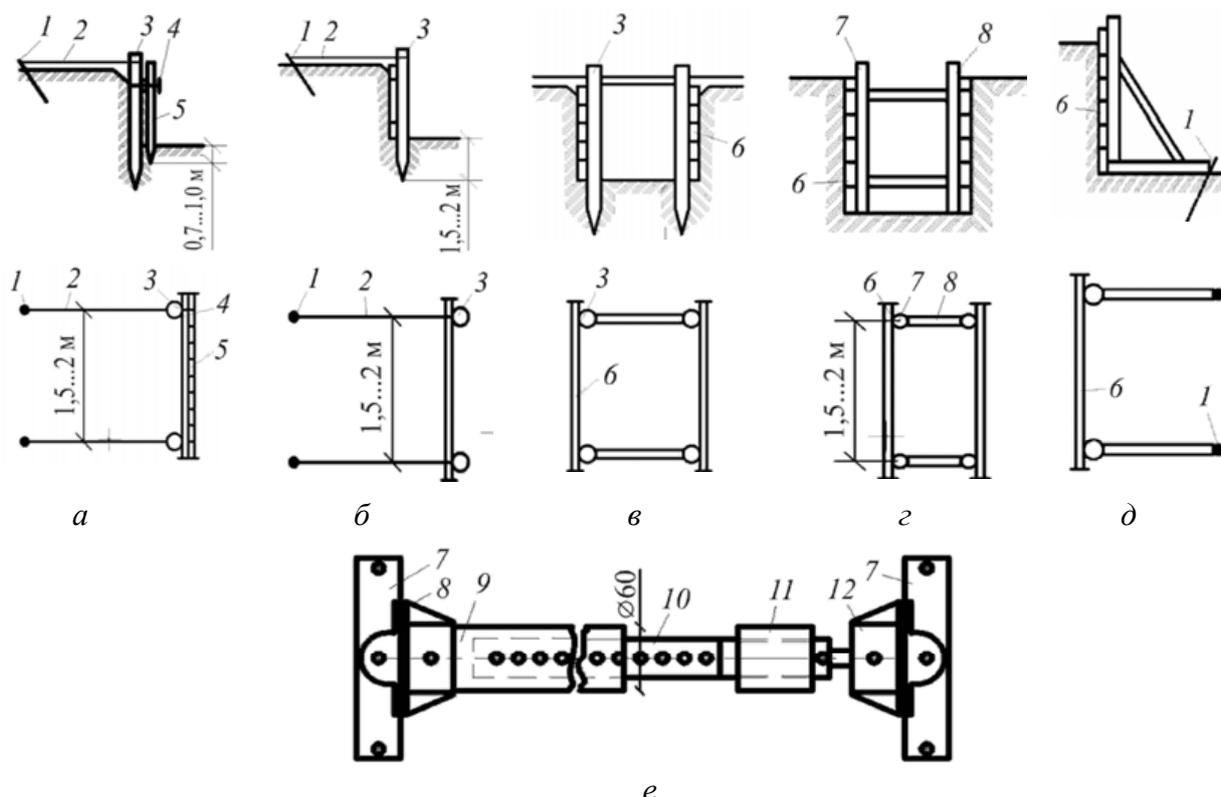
Схемы временного крепления вертикальных стенок выемок: *а* — шпунтовое ограждение; *б* — консольное; *в* — консольно-распорное; *г* — распорное (горизонтально-рамное); *д* — подкосное; *е* — инвентарная трубчатая распорная рама: 1 — анкерная свая; 2 — оттяжка; 3 — маячная свая (опорная стойка); 4 — направляющая; 5 — шпунтовое ограждение; 6 — щиты (доски); 7 — стойка распорной рамы; 8 — распорка; 9 — наружная труба; 10 — внутренняя труба; 11 — поворотная муфта; 12 — опорная часть распорки
